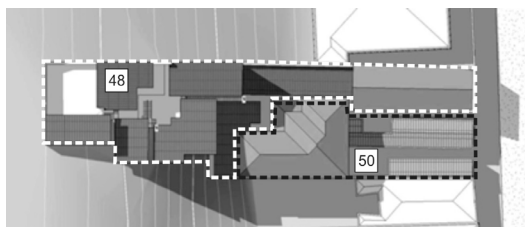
Planta baixa e Figura 20 - Vista externa da ocupação
